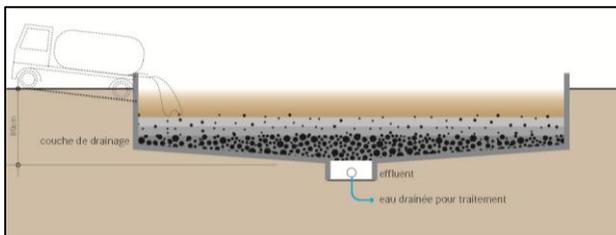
Schéma d'une coupe transversale d'un lit de séchage de boues (source: Tilley et al., 2008).
